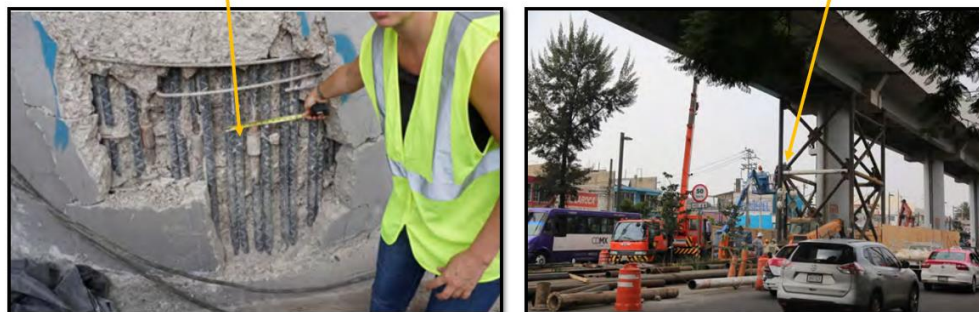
Grietas y desprendimientos en la base de la columna en el lado oeste de Amado Nervo (GEER,2018)
